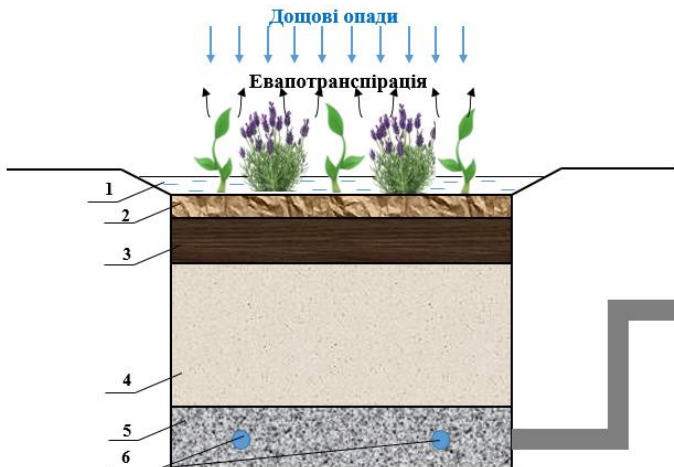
Основні елементи конструкції дощового саду в перерізі (авторська розробка): 1 – шар для утворення стовпа води; 2 – шар ґрунтопокривних матеріалів; 3 – шар ґрунтової суміші для висадки рослин; 4 – інфільтраційний/проміжний шар; 5 – шар гравію; 6 – дренажна система
